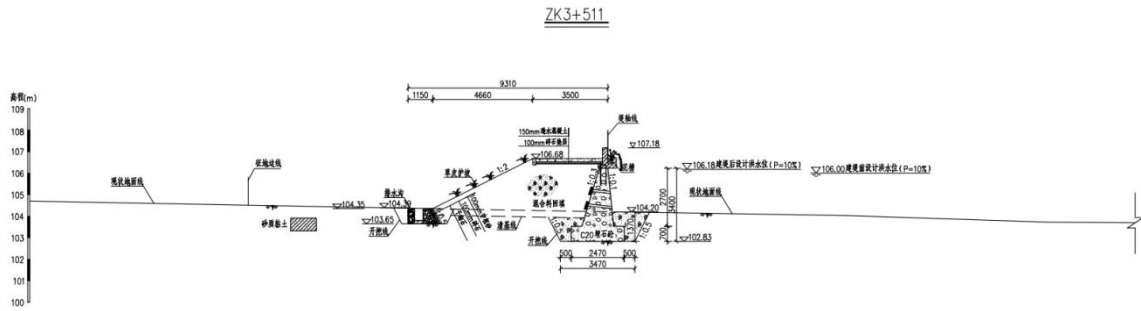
草皮护坡+混凝土挡墙 3.4m
